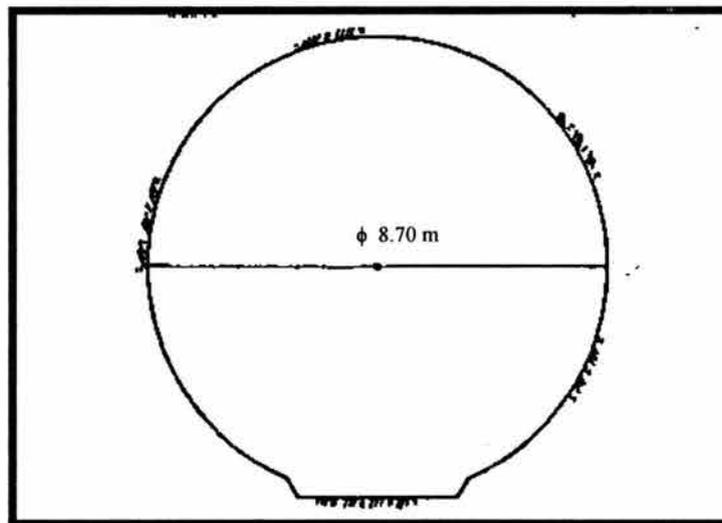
SECCIÓN-TÚNEL AUXILIAR
